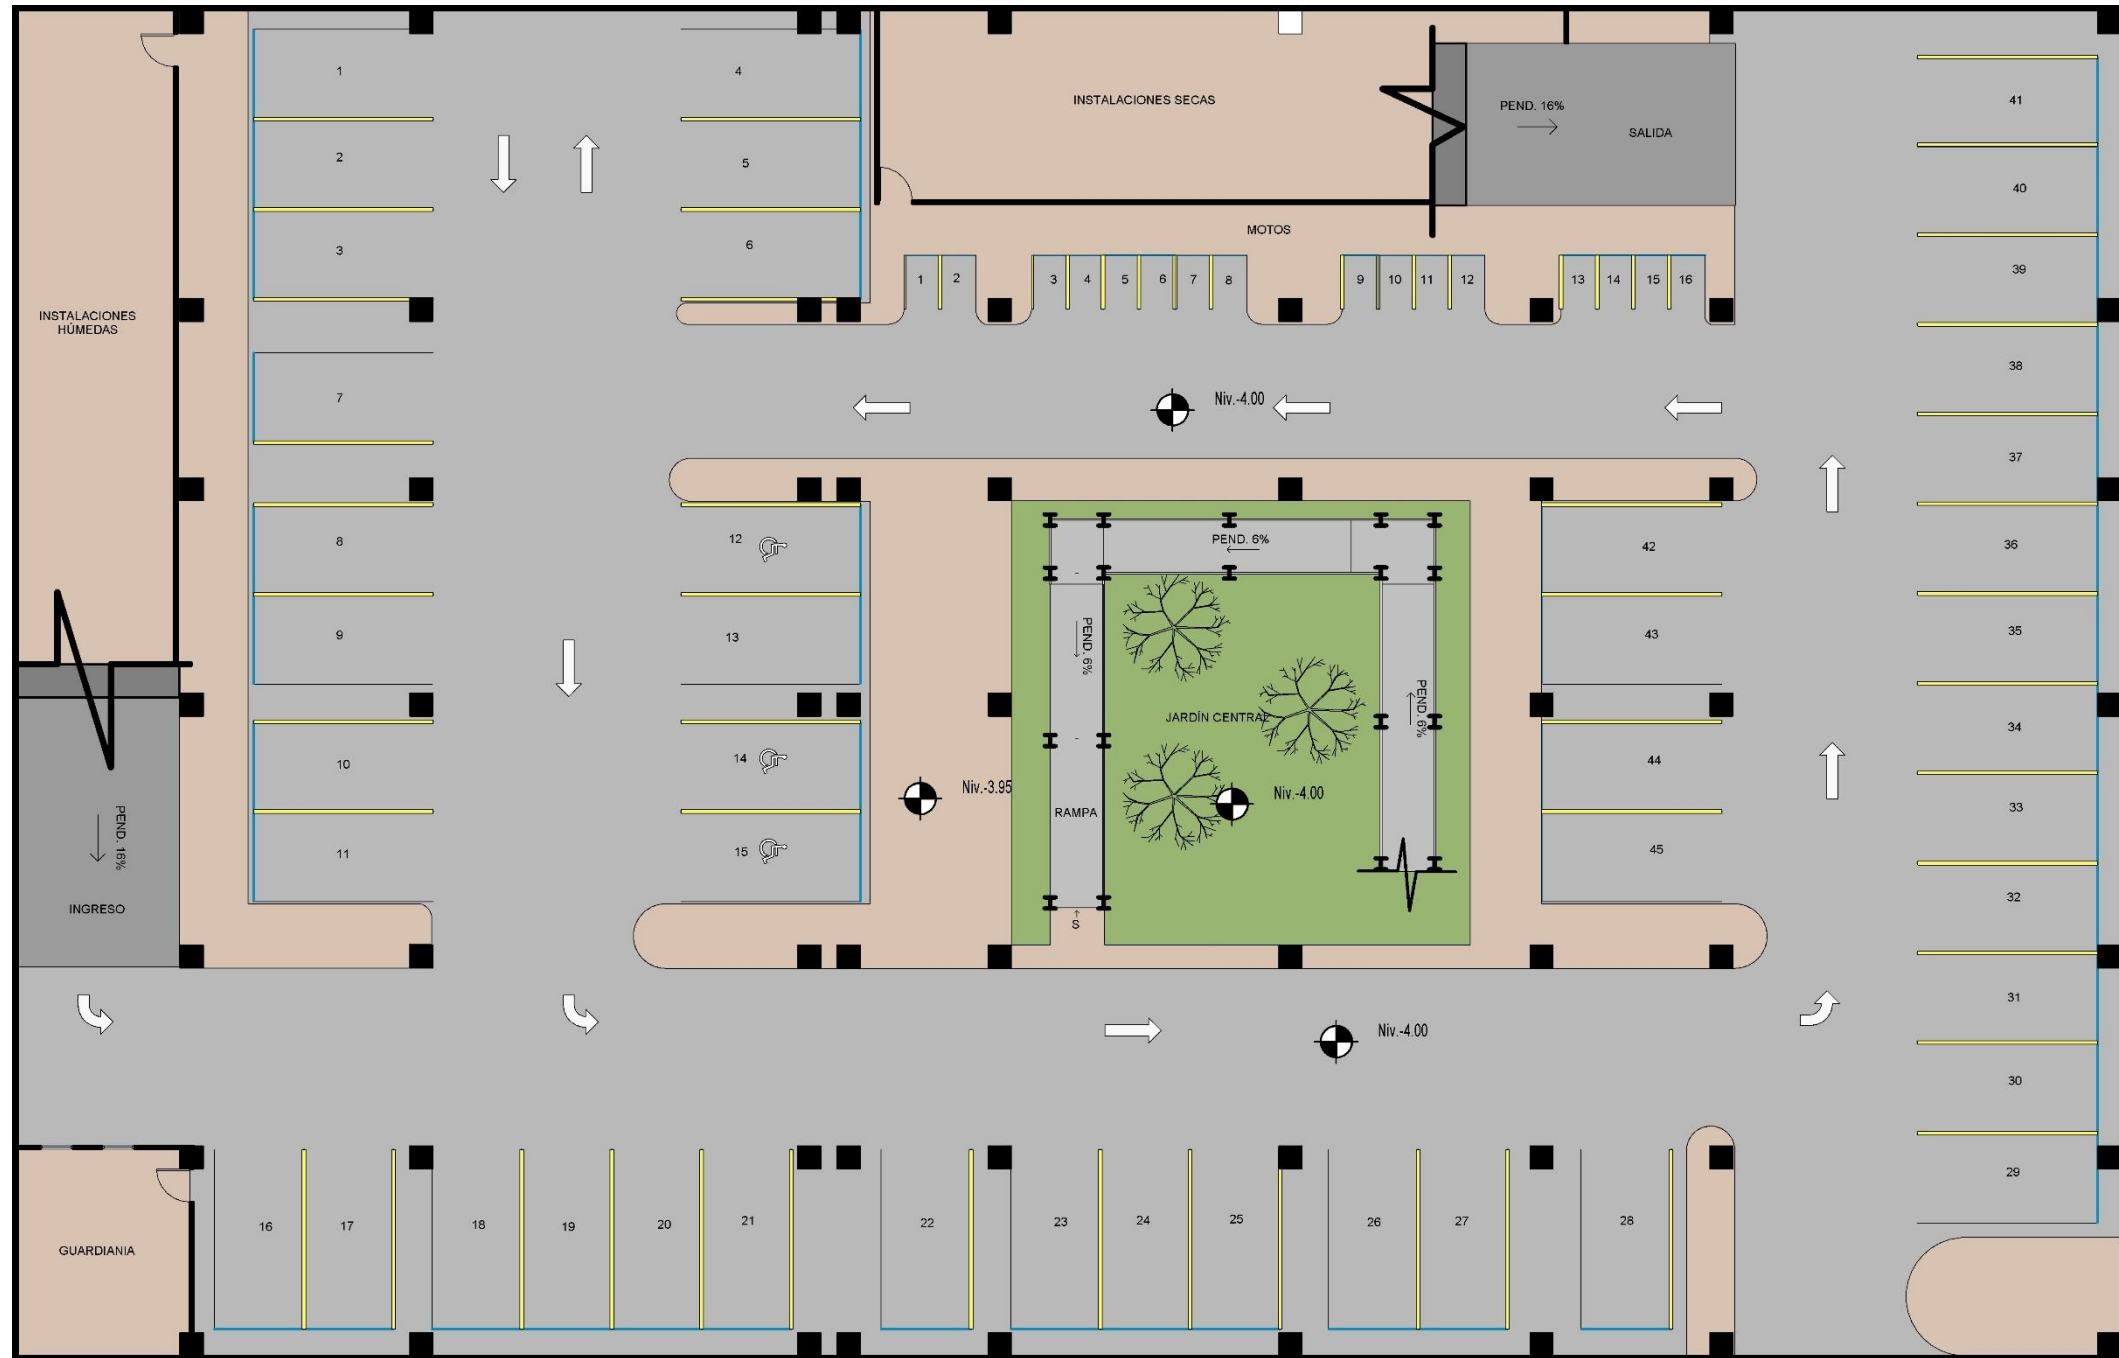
Planta Sótano. Fuente: Elaboración propia.
